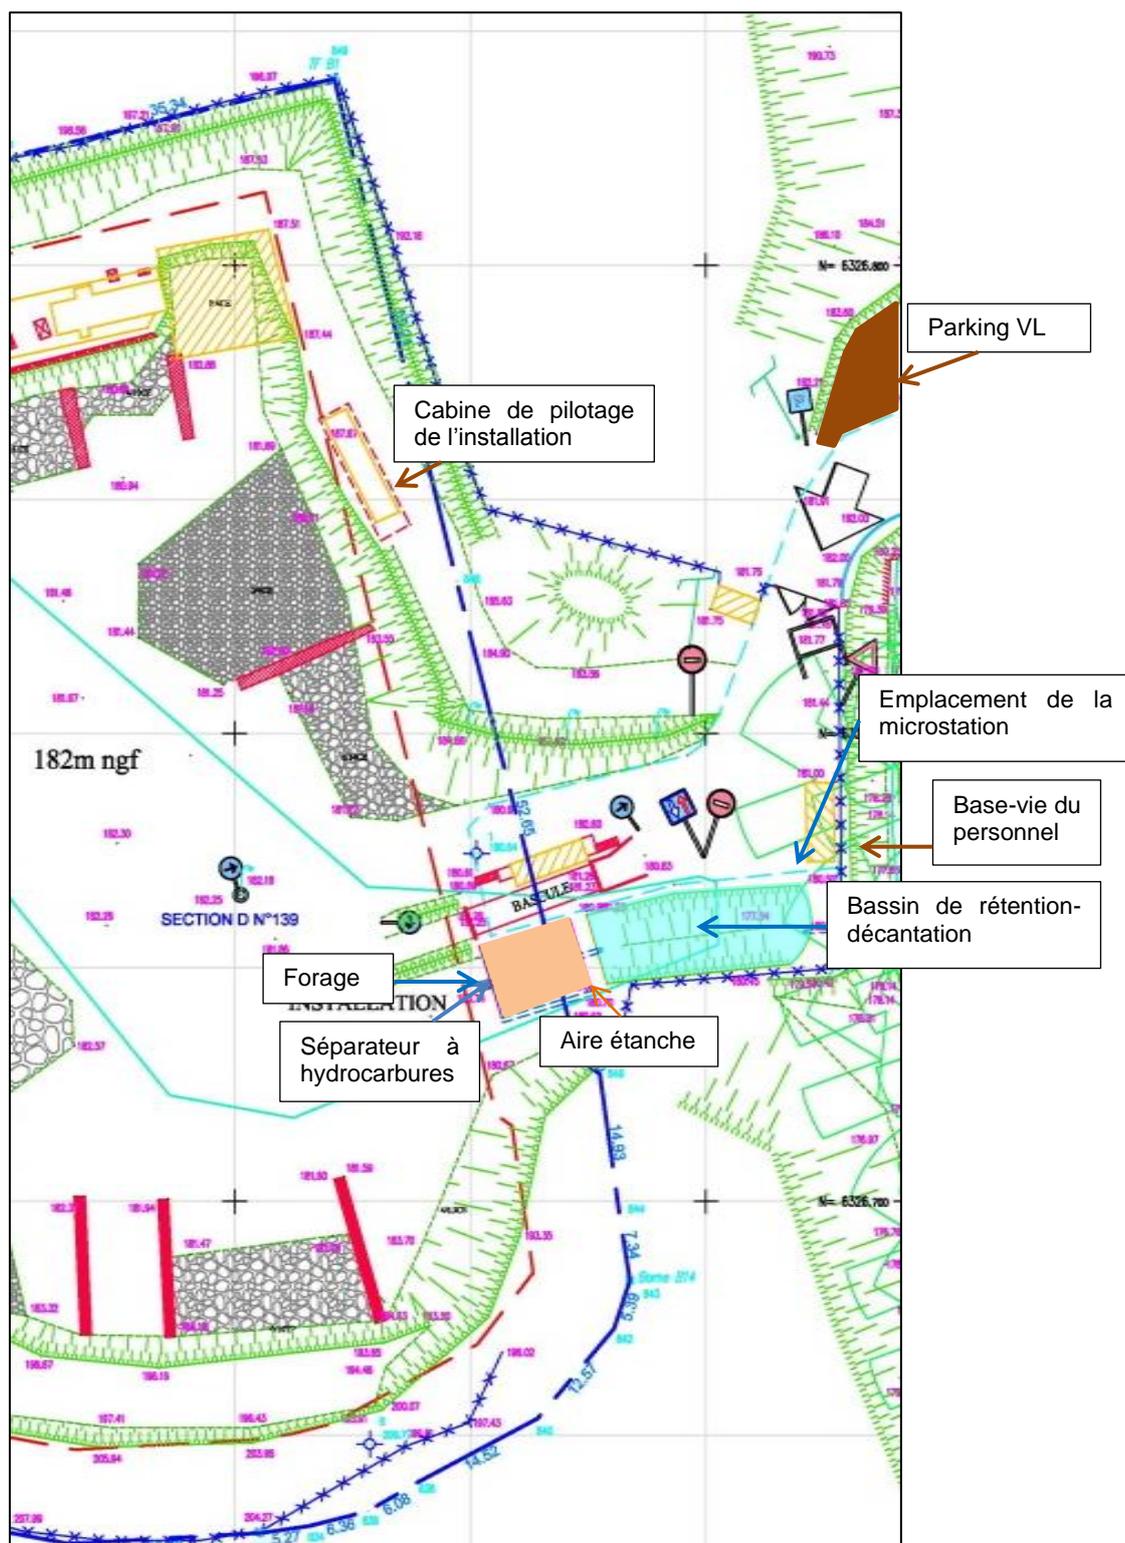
Plan de masse des installations annexes (entrée, accueil et base de vie)
